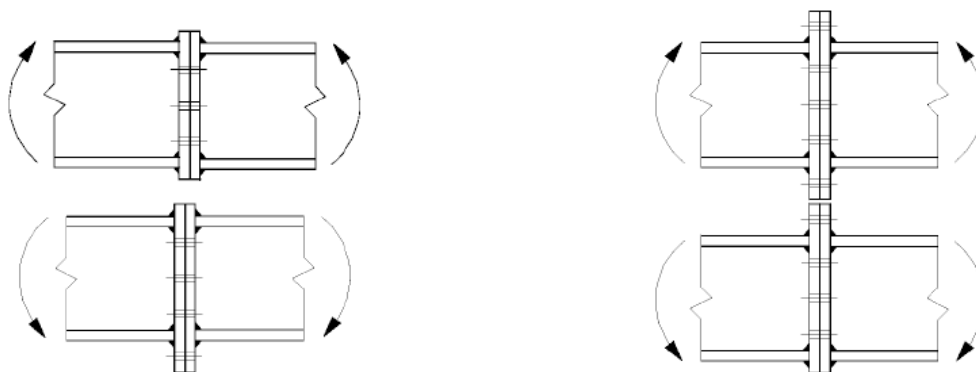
Empalmes atornillados en vigas con chapas frontales soldadas
